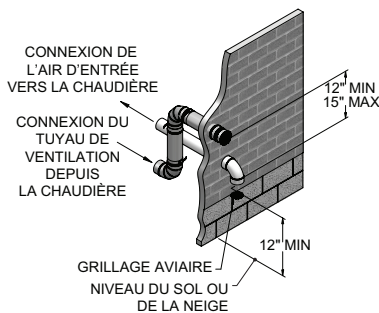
D Alternier la ventilation Disposition - typique Terminaison d'air murale classique en acier inoxydable et ventilation avec raccords fournis sur place
